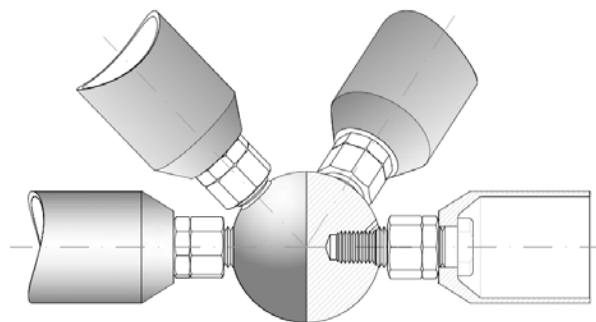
Detalle en alzado y sección de la conexión de las barras al nodo esférico, sistema Ortiz de Lanik.
